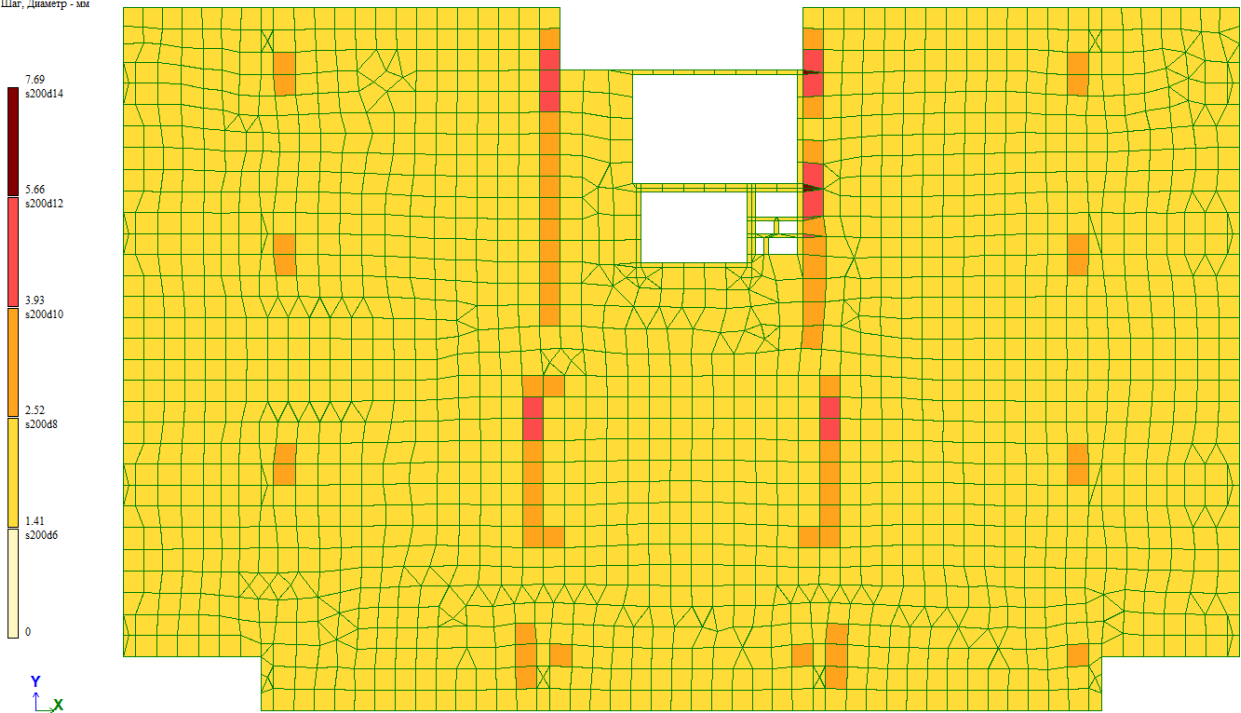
Верхне армивання плити першого поверху вздовж осіХ
